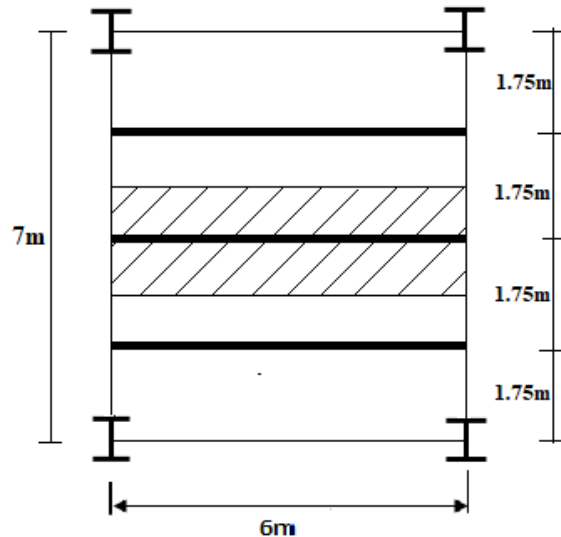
Schéma du positionnement des solives plancher courant.
